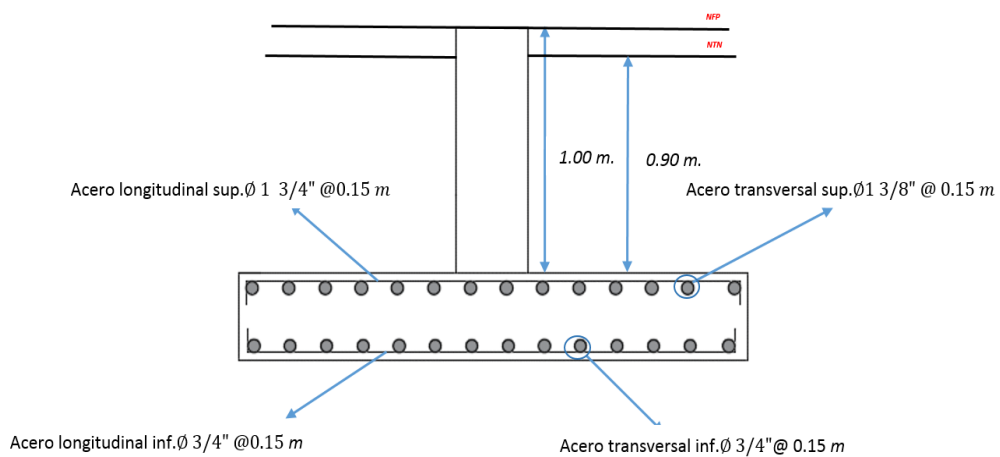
26. Detalle losa de cimentación edificio 12 pisos
